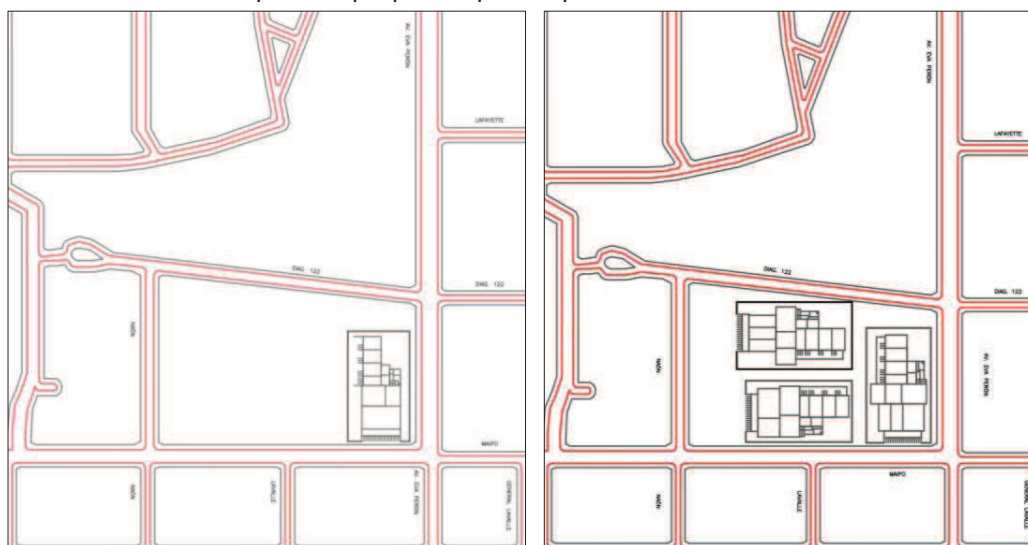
Izquierda. Plan inmediato de la planta de tratamiento de RAEE. Derecha. Plan futuro de la planta de tratamiento de RAEE.
